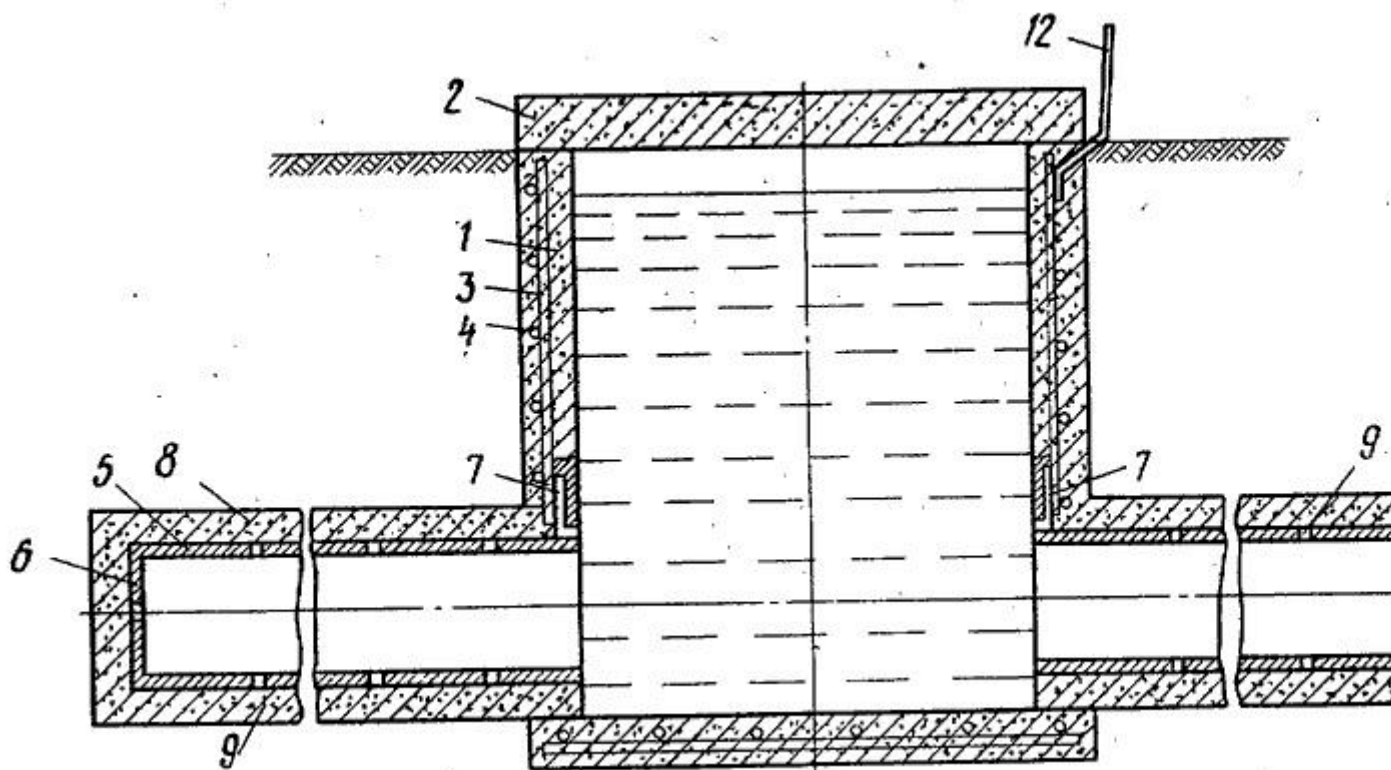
Заземлитель для засушливых районов (1 - железобетонная цилиндрическая ёмкость; 2 - железобетонная съёмная крышка; 3 - стальная арматура; 4 - поперечная арматура; 5 - металлическая труба; 6 - заглушка; 7 - соединительный элемент; 8 - влагопоглощающий материал (бетон/цемент); 9 - дренажные отверстия; 12 - вывод для подключения заземляющего проводника).
